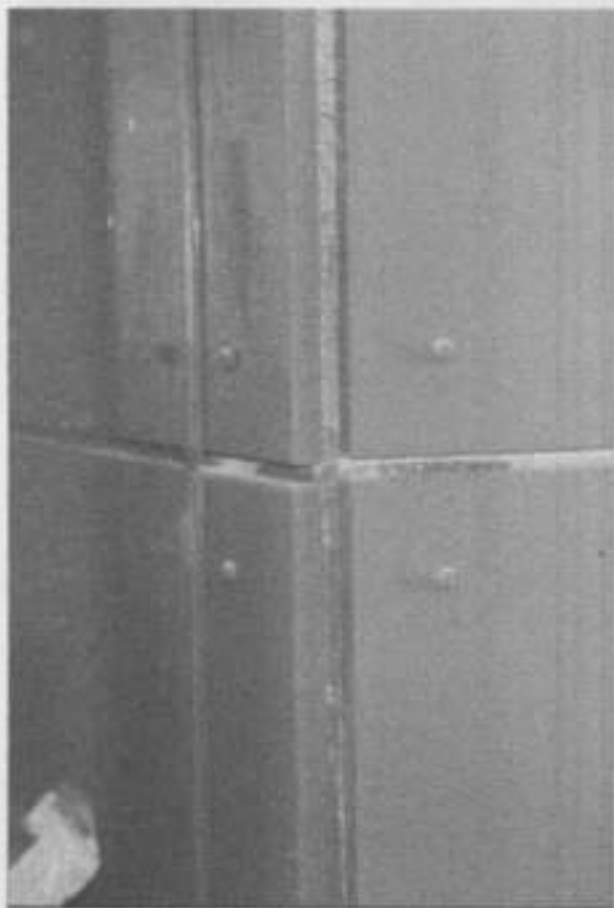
Pormenor da aplicação do Viroc na caixa do elevador, cota 99.90
